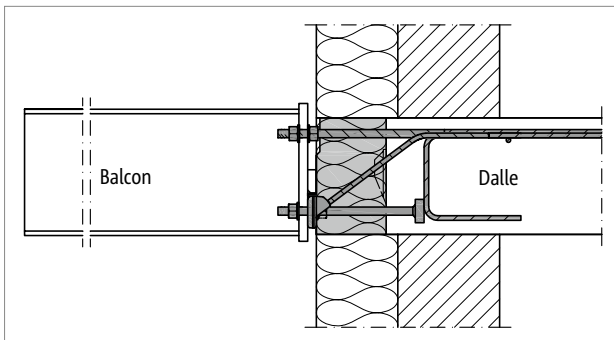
Schöck Isokorb® XT type SK : Le corps isolant affleure le nu extérieur de l'isolation du mur grâce à la saillie de la dalle vers l'extérieur. Ce faisant, les distances aux bords latéraux doivent être respectées
